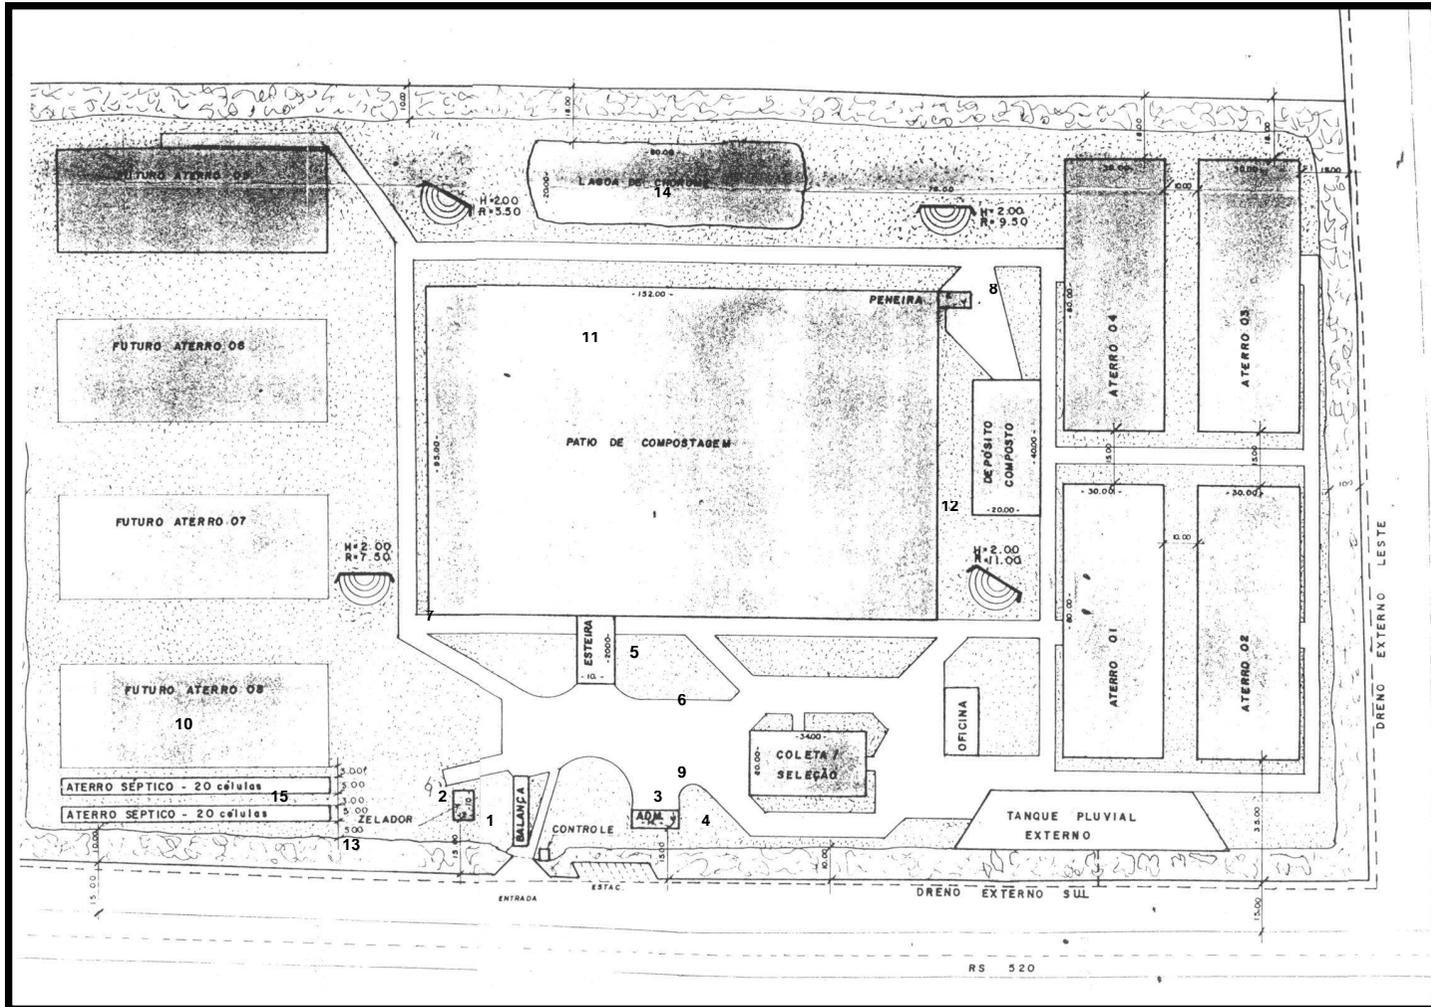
Layout das instalações do CITRESU, conforme projeto executivo de 1997.
